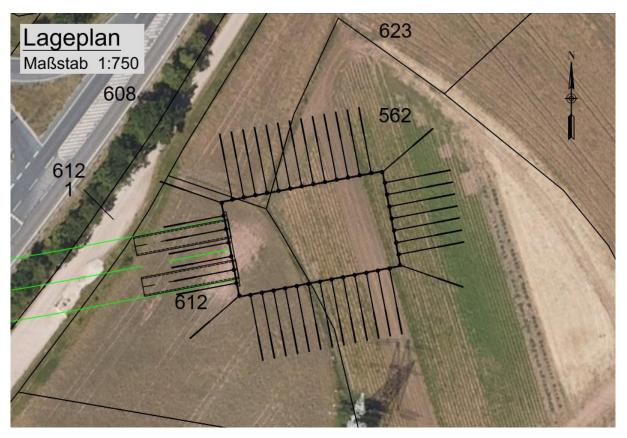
Planung Lage Startbaugrube gemäß Unterlage 7.3
